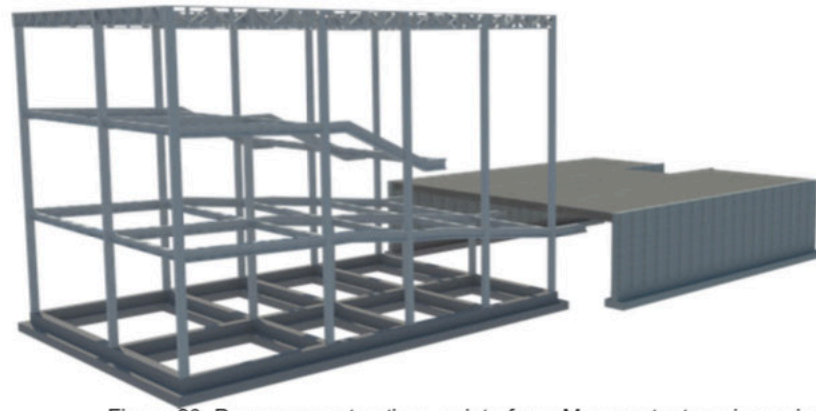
Proceso constructivo - quinta fase: Muro portante, primer piso
